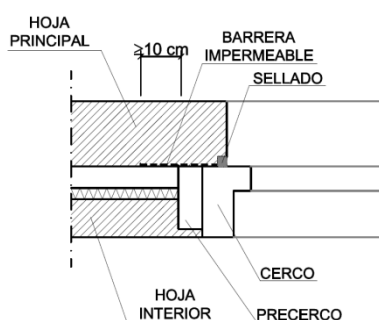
Sección arranque muro fachada. 2016. Creación propia a partir de modelo REVIT.
